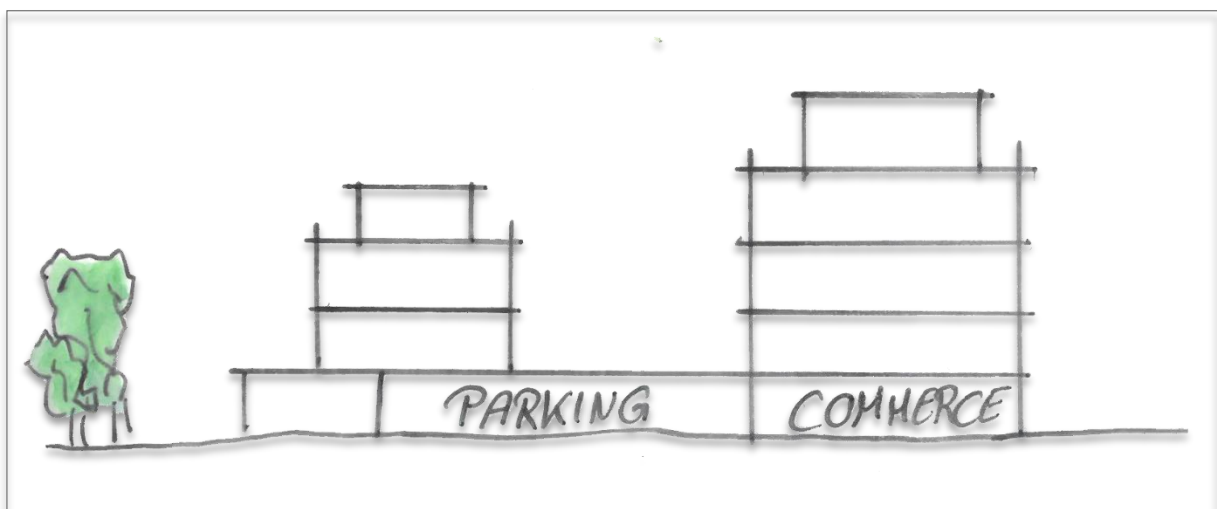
Prinzipschnitt A-A' (siehe Abb. 18) durch das Plangebiet. Im linken Bildteil sind die Wohngebäude, im rechten Bildteil die Wohn- und Geschäftsgebäude an der „Route du Vin“ dargestellt. Das Parkhaus befindet sich auf Höhe der Erdgeschosse, unterhalb der Platzfläche. Quelle: CO3 2019
